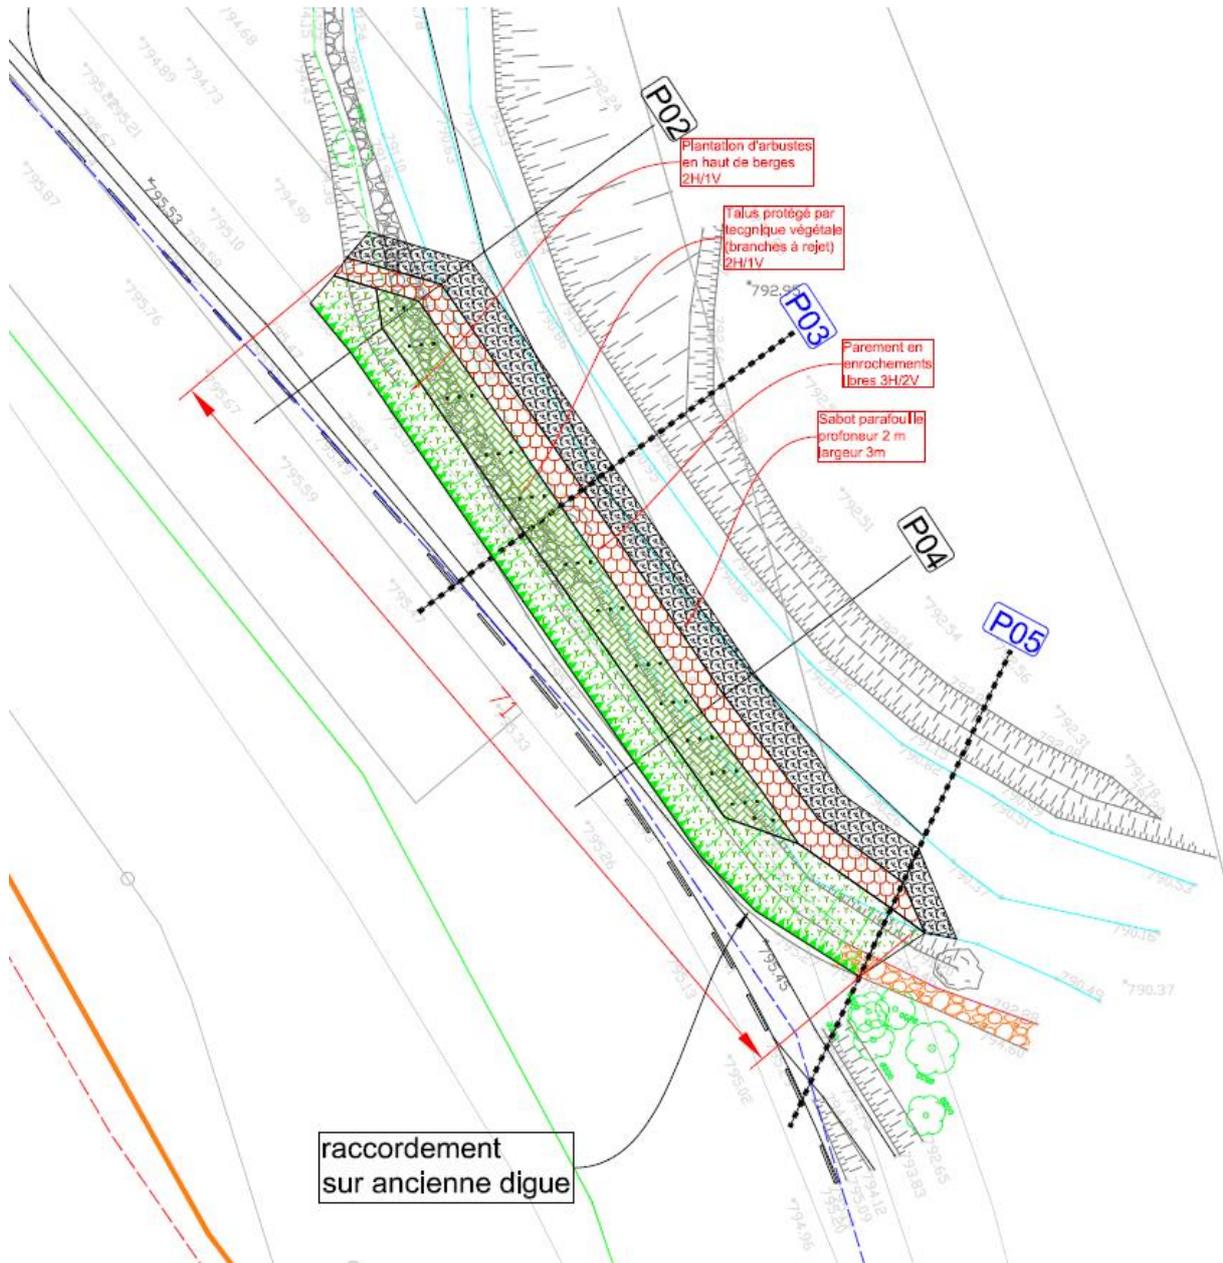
Site 10 : vue en plan et coupe de confortement à P02
